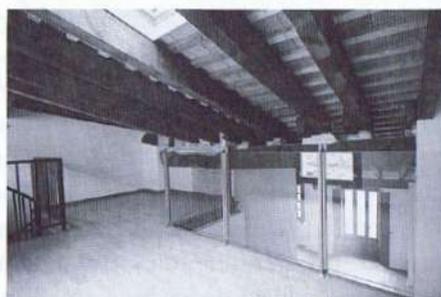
Imagen de un espacio interior de la última planta tras acabar la restauración del edificio.
